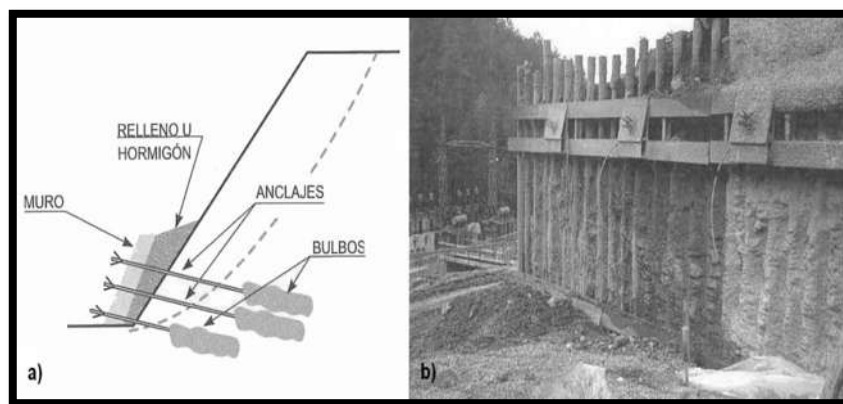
Estructuras ancladas: a) Muro de concreto armado anclado; b) Pantalla de pilotes anclada (Modificado de González de Vallejo et al., 2002).
